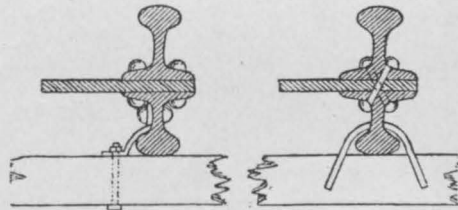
Schienenträger mit eingemietetem Querverbände.
